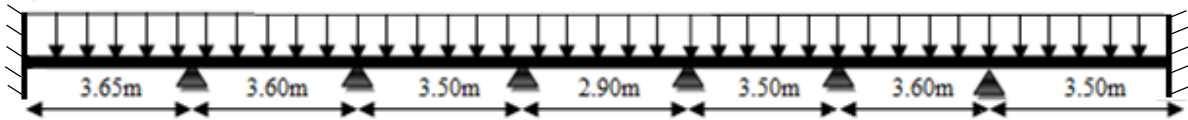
schéma statique de la poutrelle à sept travées
